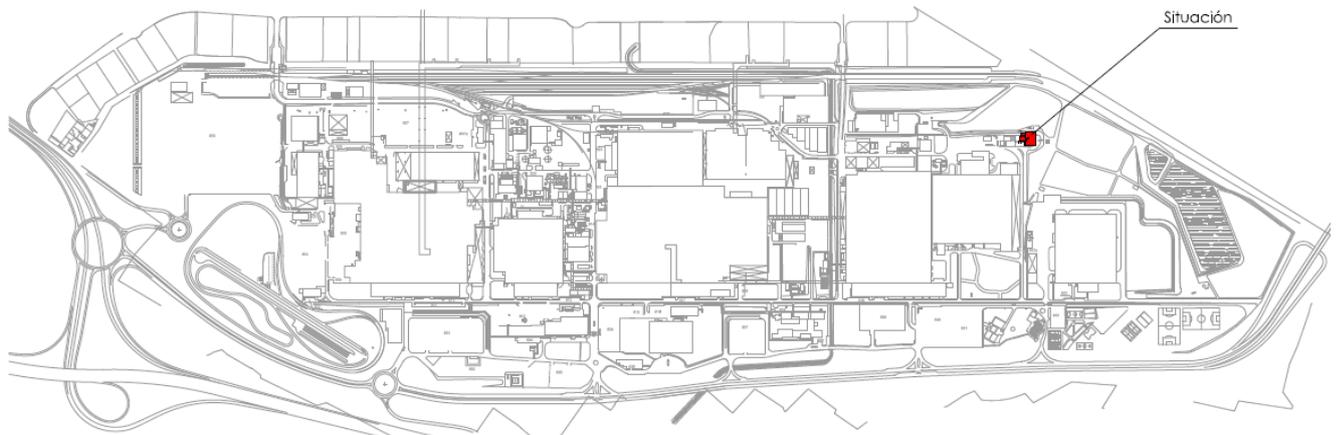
Plano emplazamiento dentro de la Factoría Ford
